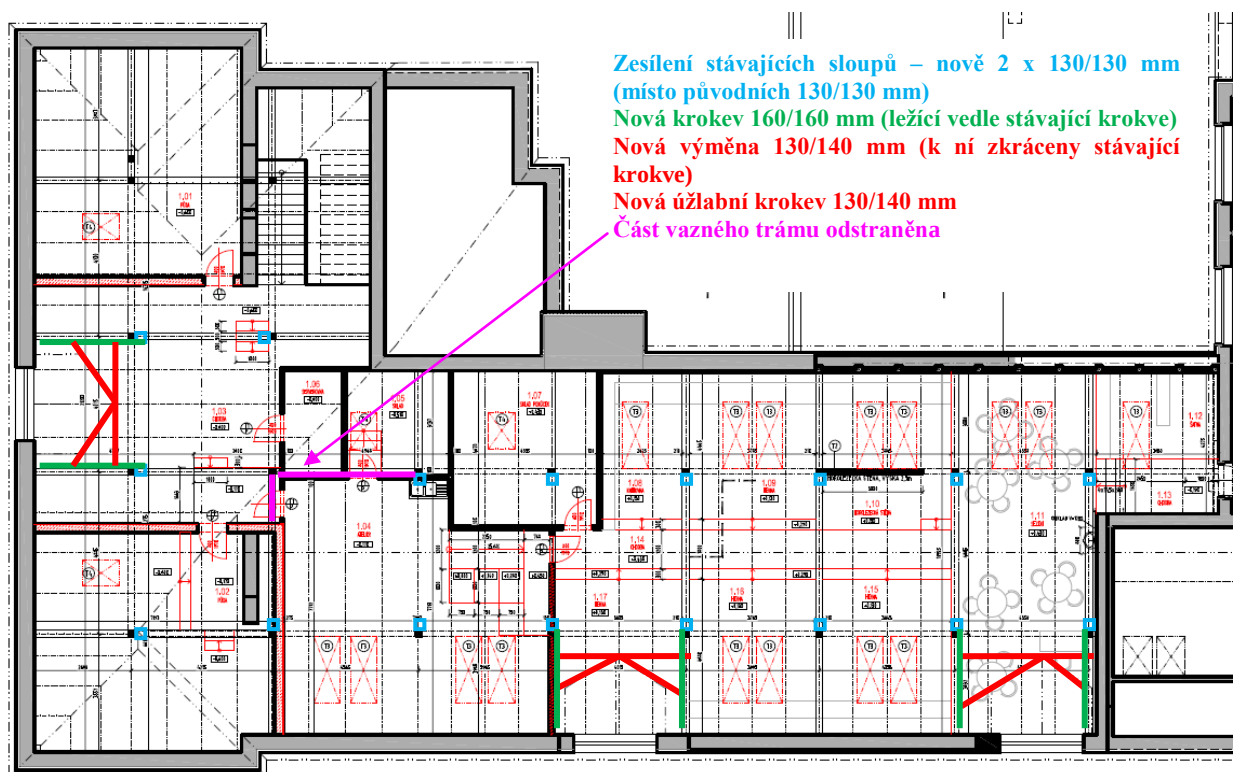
Půdorys podkrovní – stávající stav + bourací práce
